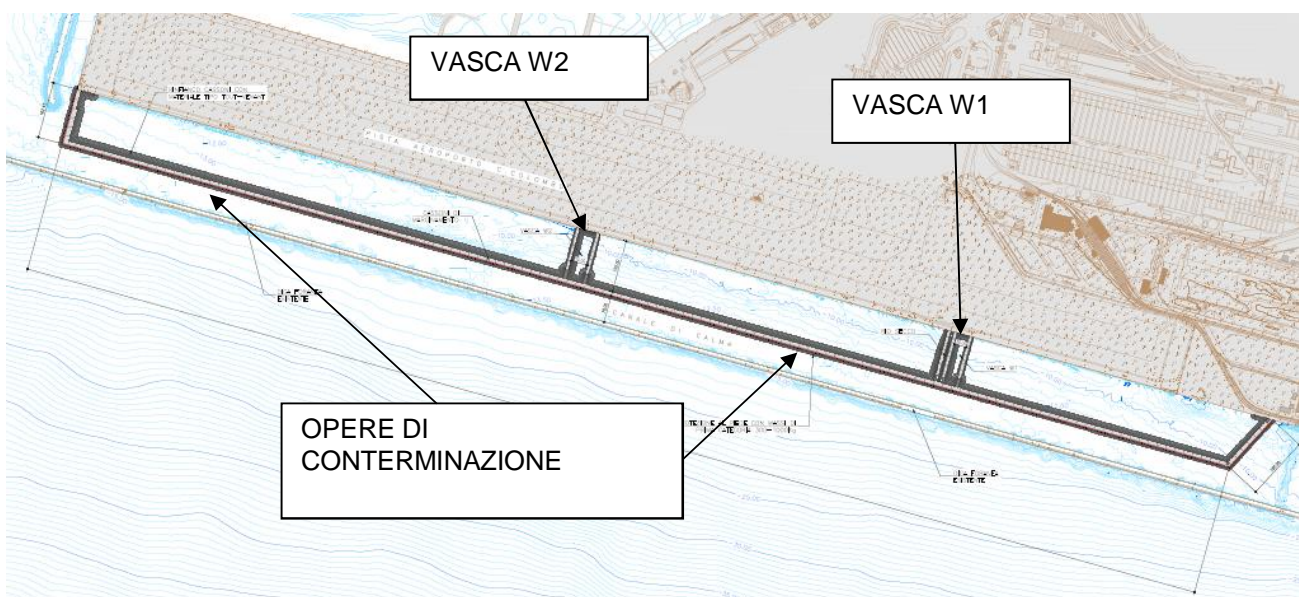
Planimetria generale di progetto (estratto da 110729-LL05-PE-DG-GEN-00000-00000-R-GEN0002-3)
